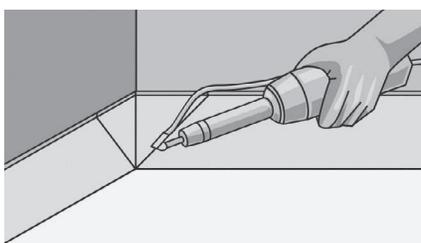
Для соединения стыков используйте метод горячей сварки и необходимое оборудование.
